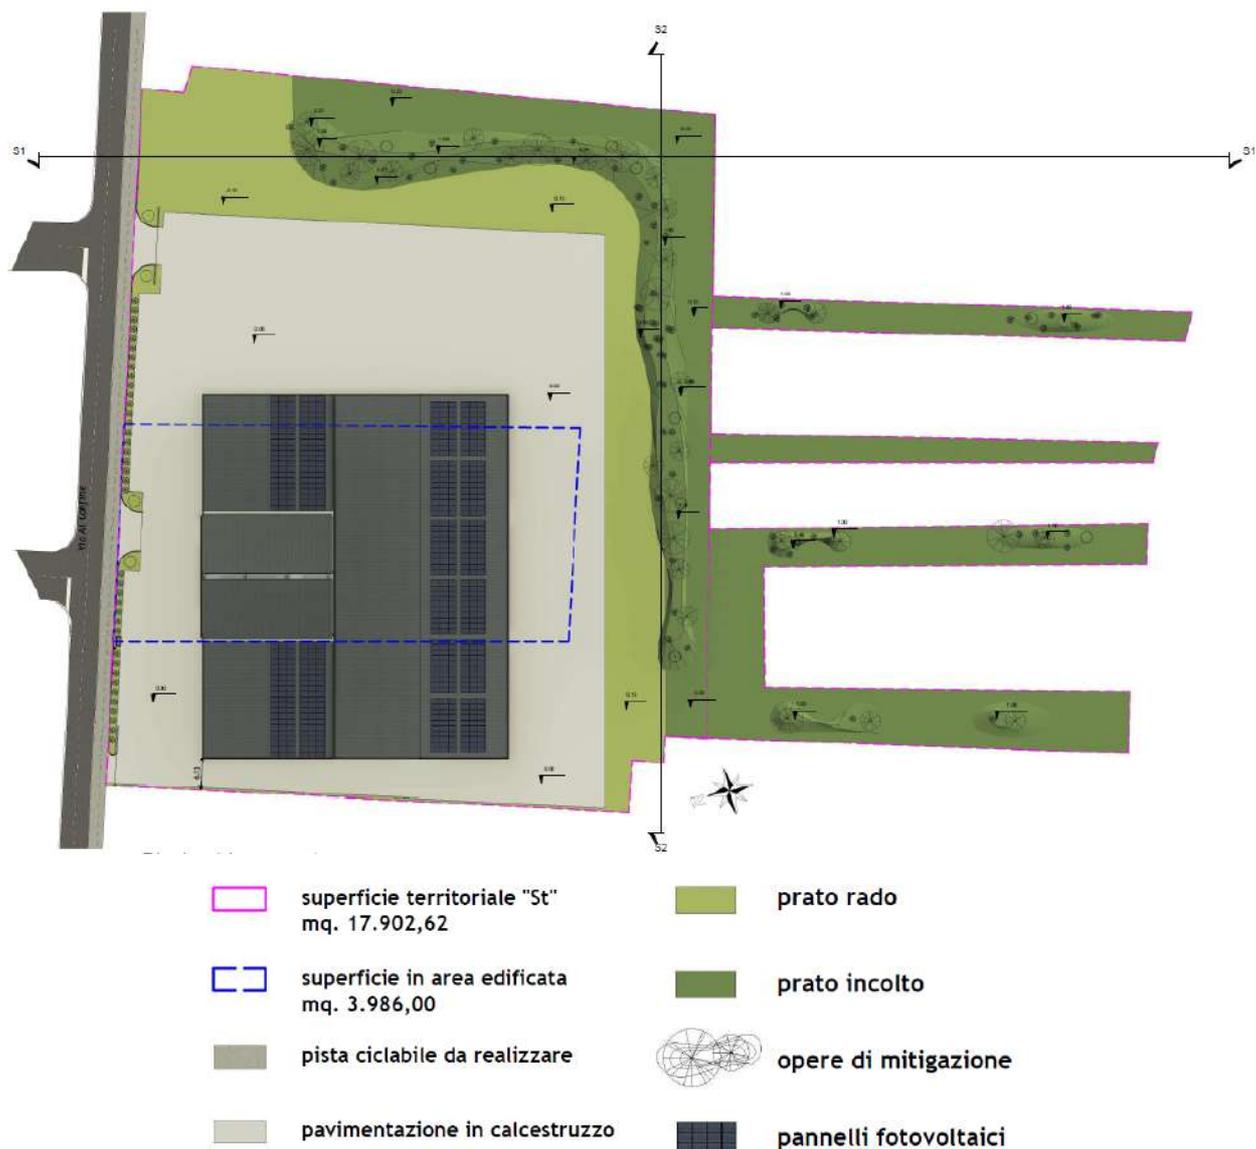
Estratto da progetto di ampliamento e sistemazioni esterne – planimetria generale
